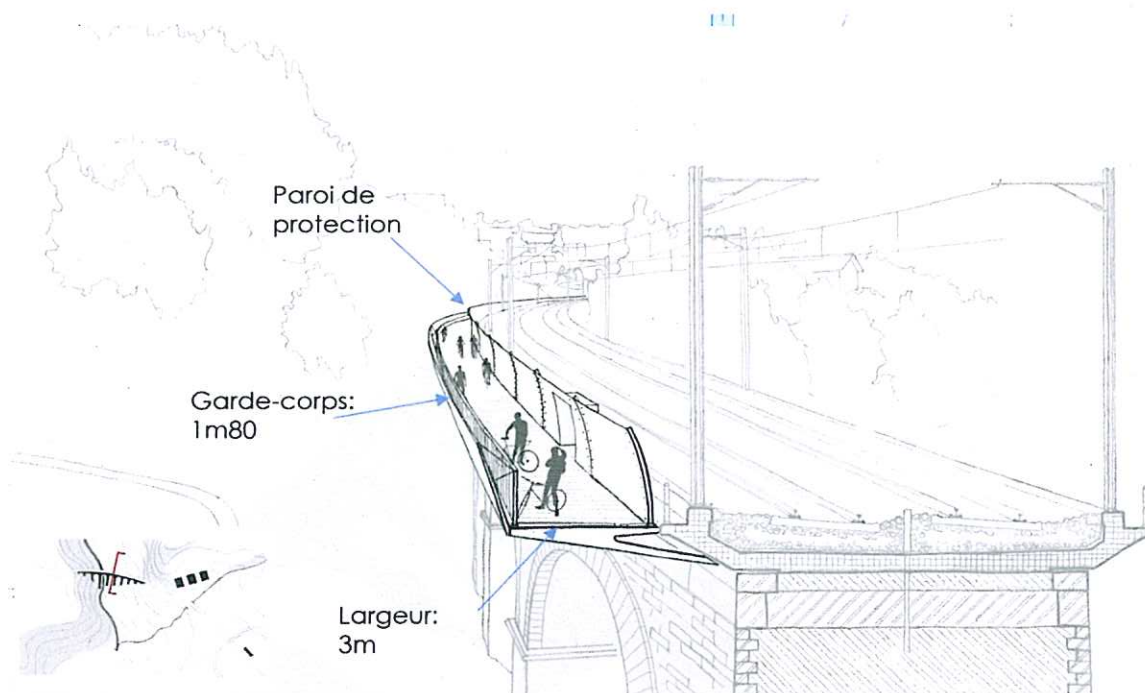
coupe de la passerelle le long du viaduc CFF de Rochettaz. © Glatz & Delachaux, 2024
